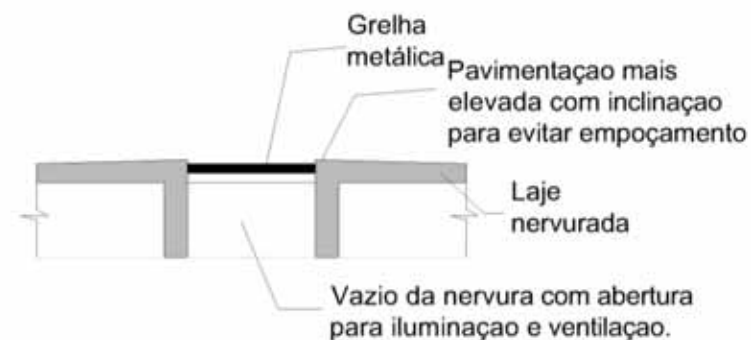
Detalhe de corte da grelha metálica sobre as aberturas de ventilação. Uma pequena elevação evita o acúmulo de água sobre a laje e queda desta sobre a avenida.
